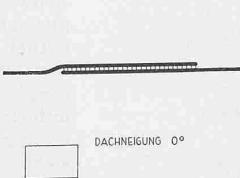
Klebedach. Fuge zwischen Deckungselementen nicht nur überdeckt, sondern gedichtet. Dachfläche kann horizontal werden
